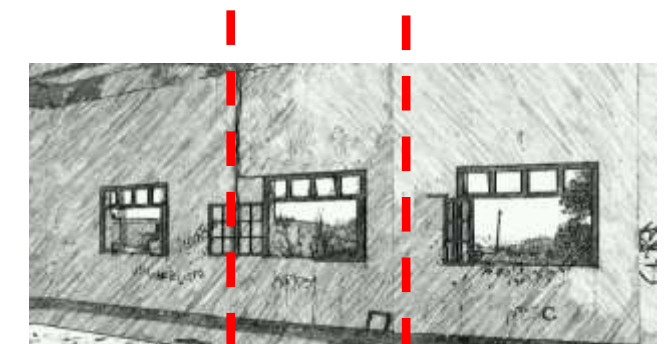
Vista Interior de la edificación. Modulación. Fuente: García (2014)
